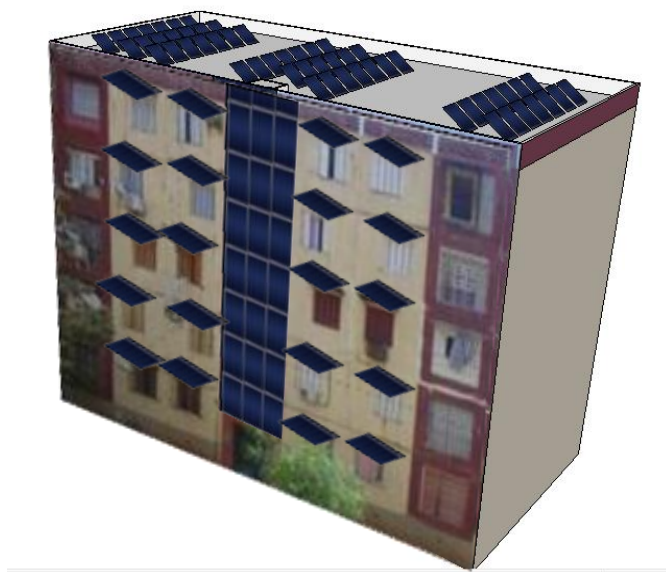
l'installation des capteurs solaires sur la façade et en auvent
